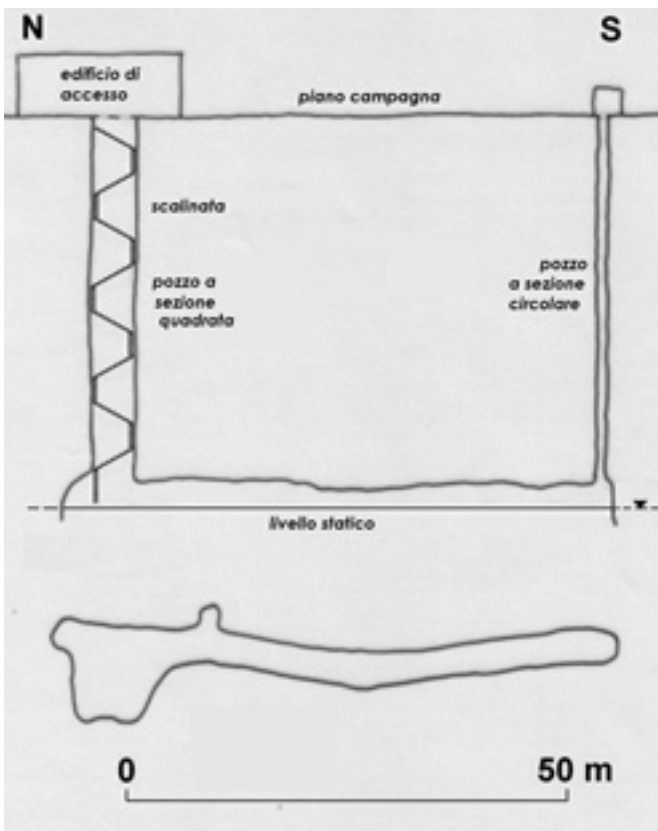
Sezione verticale e planimetria schematica del pozzo Cozza-Guardati.
